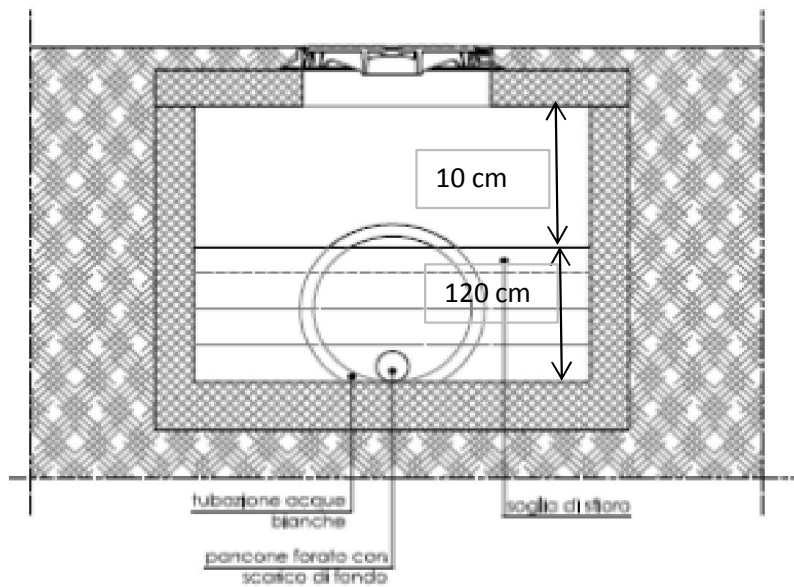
Esempio sezione fossato tipo perimetrale ai lotti
